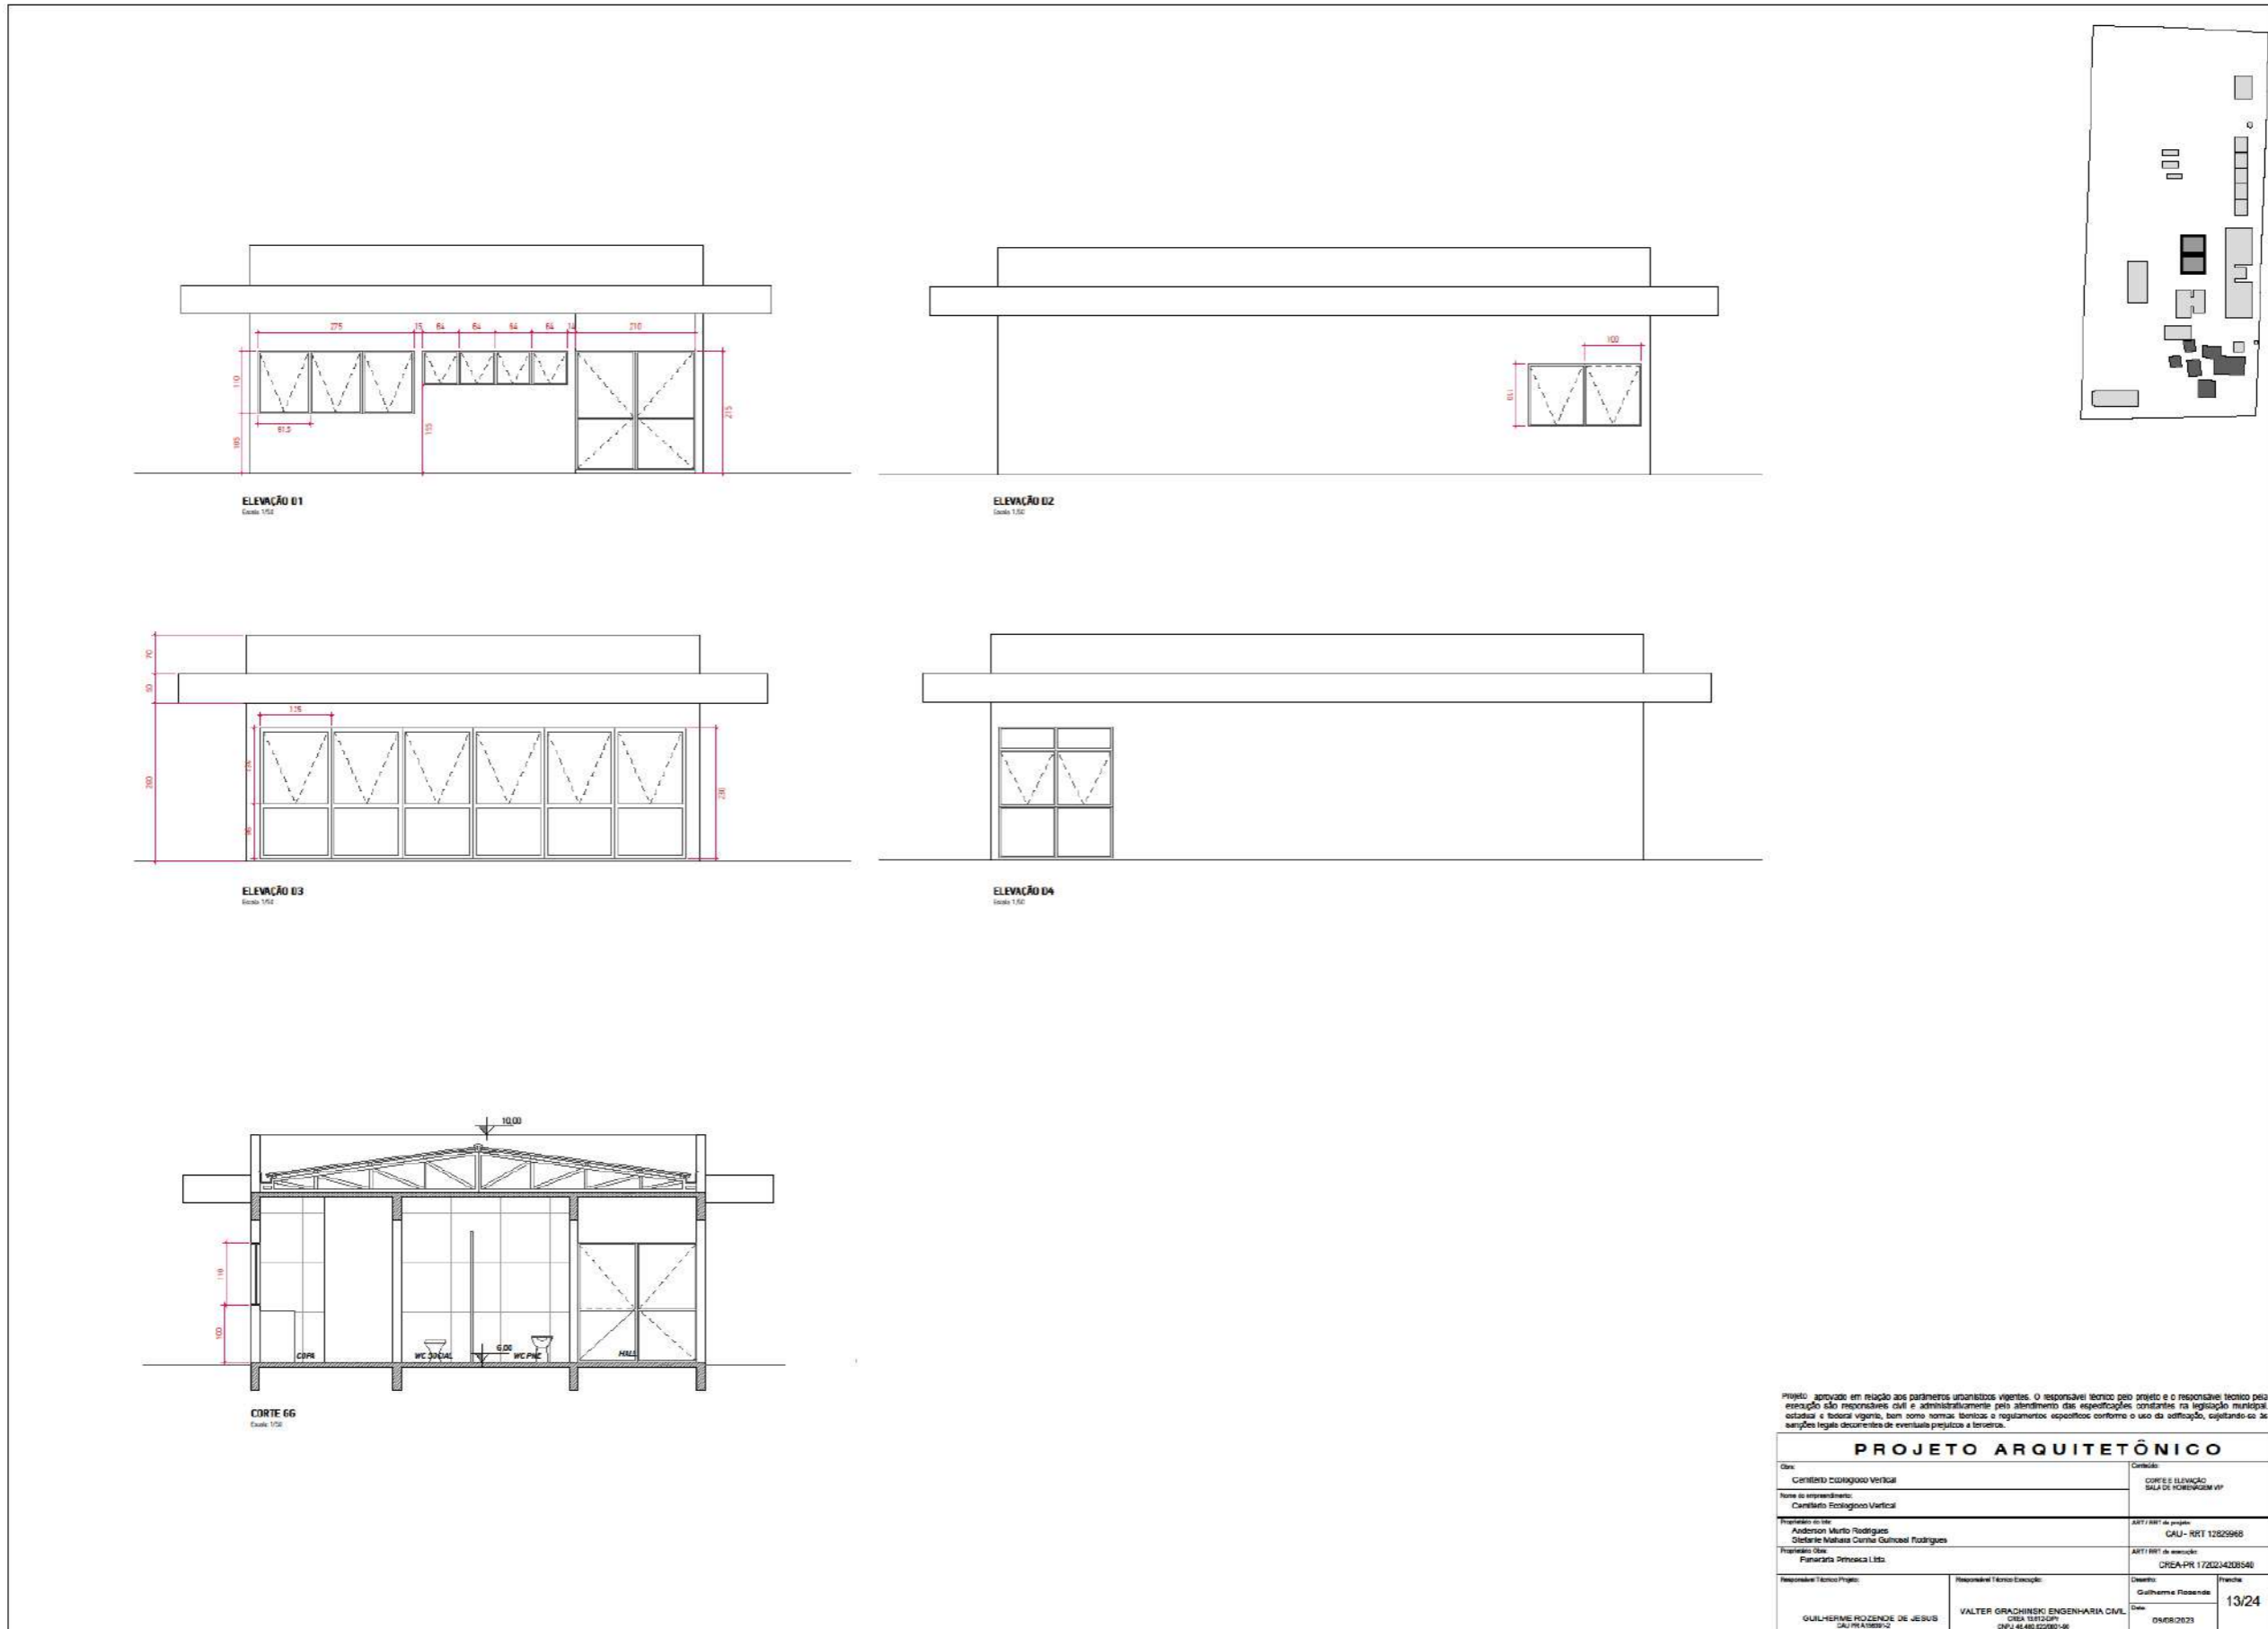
Projeto Arquitetônico – Prancha 13-24.
